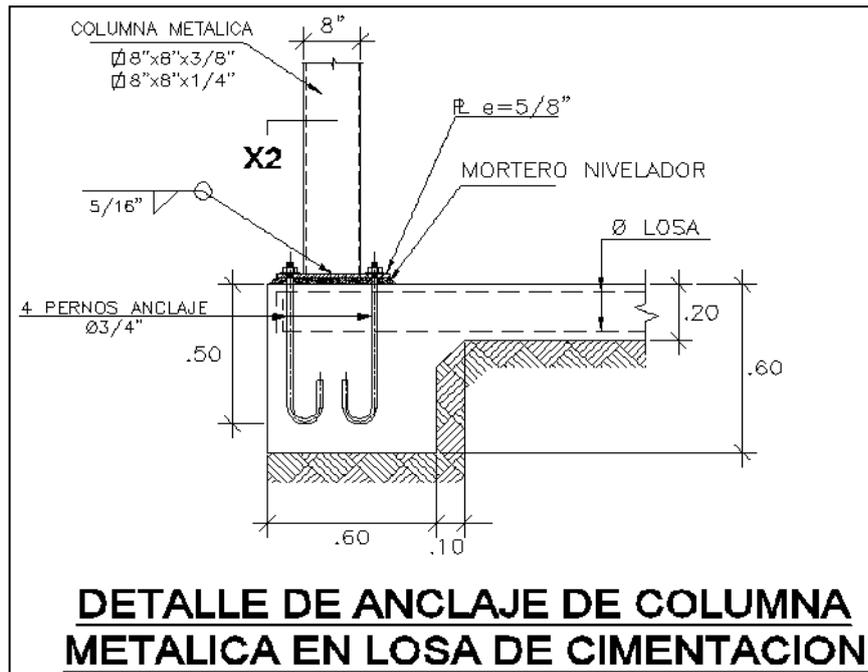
Detalle de anclaje. FUENTE: Elaboración Propia
